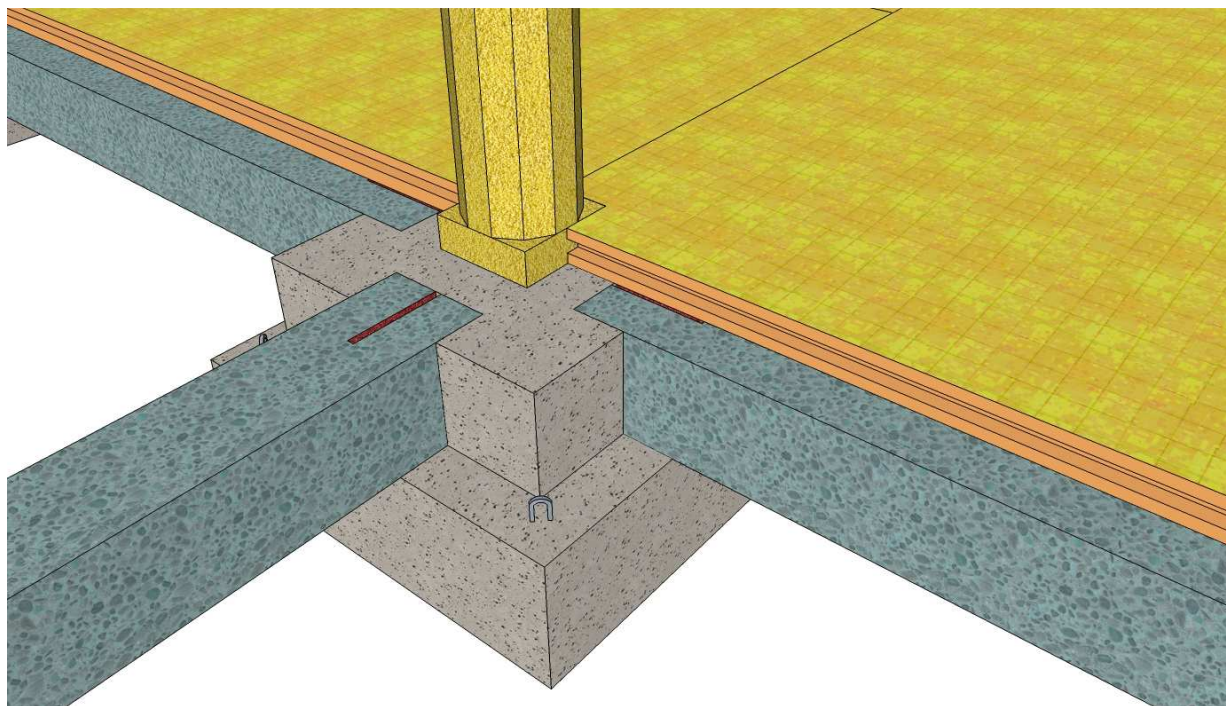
assemblage (semelle+ longrine+dalle+poteau)
